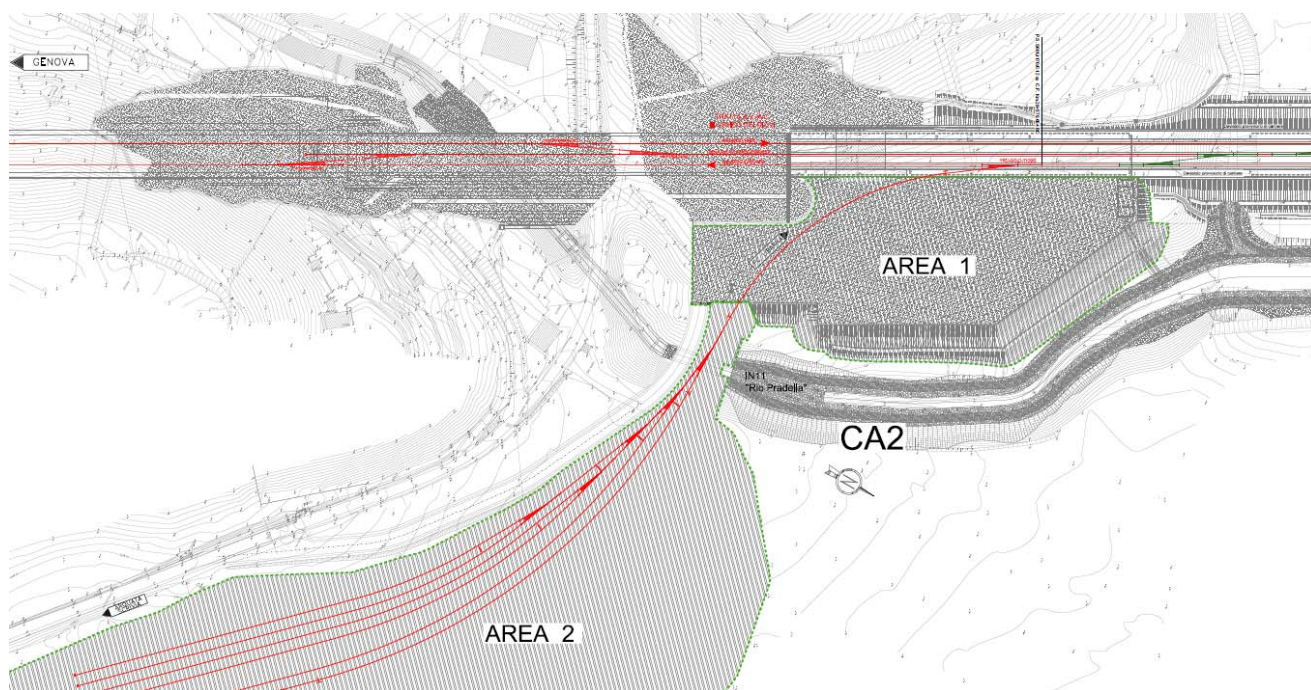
Stralcio planimetrico con localizzazione del Rio Pradella
